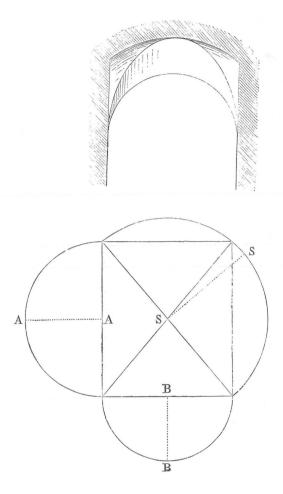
Bóveda de arista bizantina sobre planta rectangular
